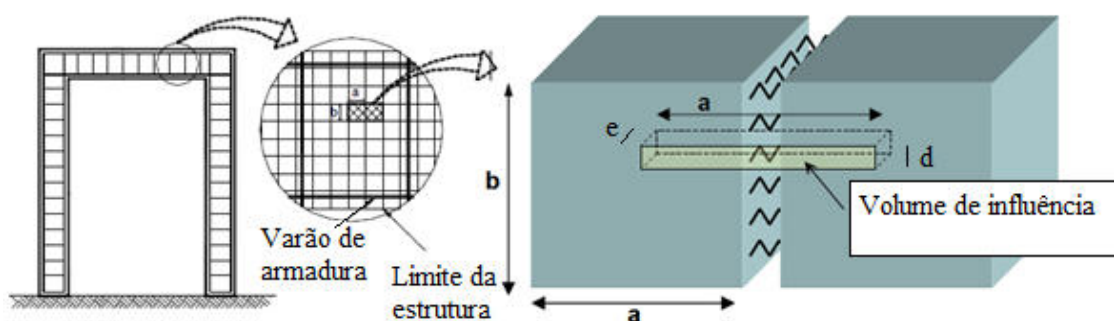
Configuração de dois elementos (adaptado de [2])
